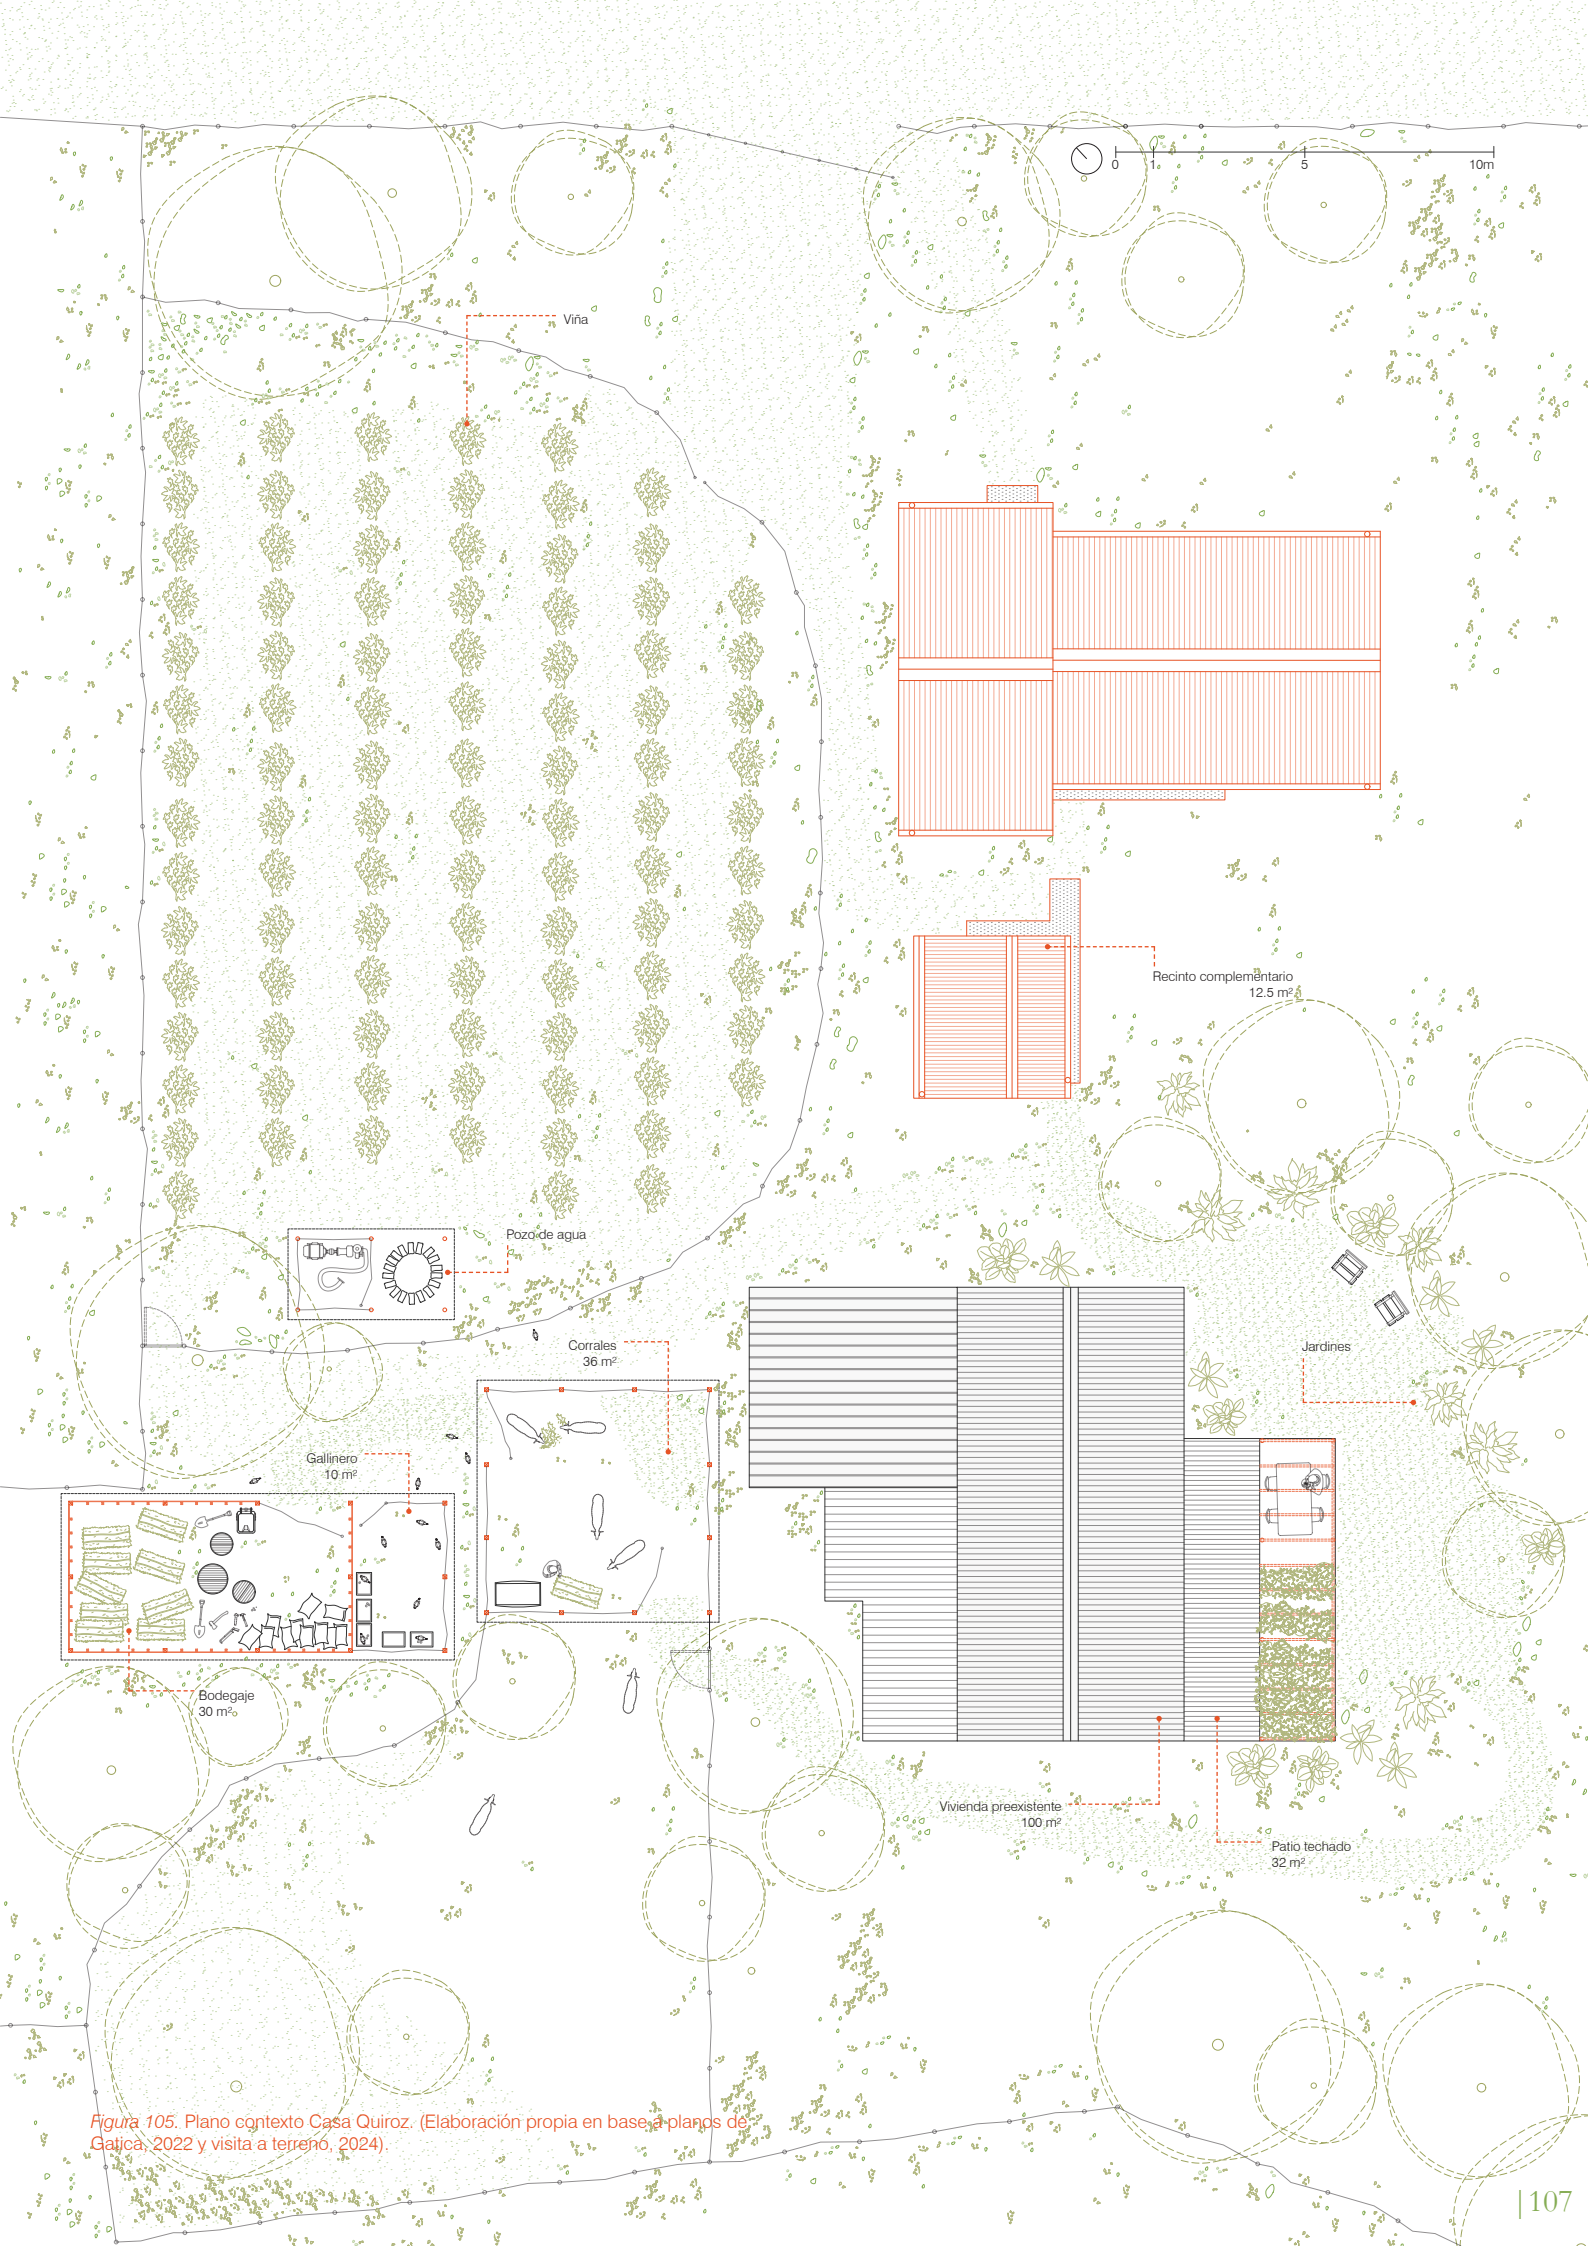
Plano contexto Casa Quiroz. (Elaboración propia en base a planos de Gajca, 2022 y visita a terreno, 2024).
